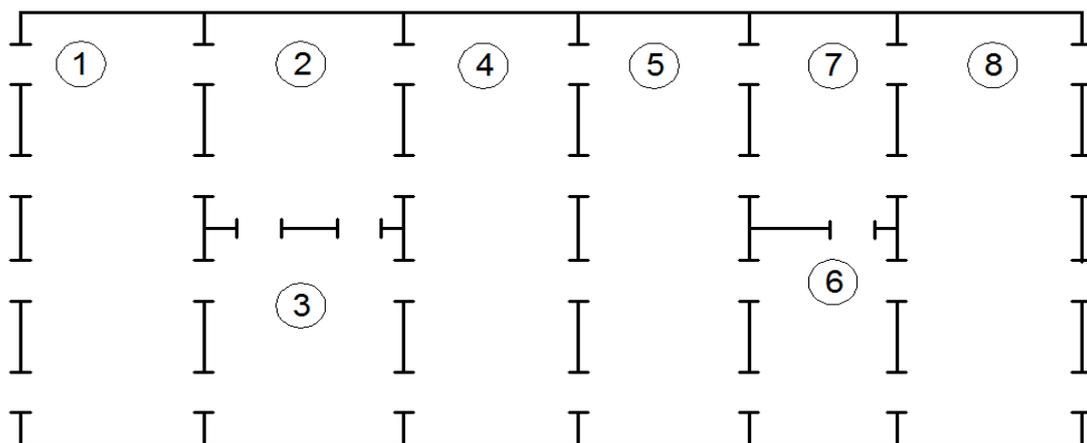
Схематичное расположение отделений заготовительного корпуса завода приборостроения при параллельном блокировании корпусов
